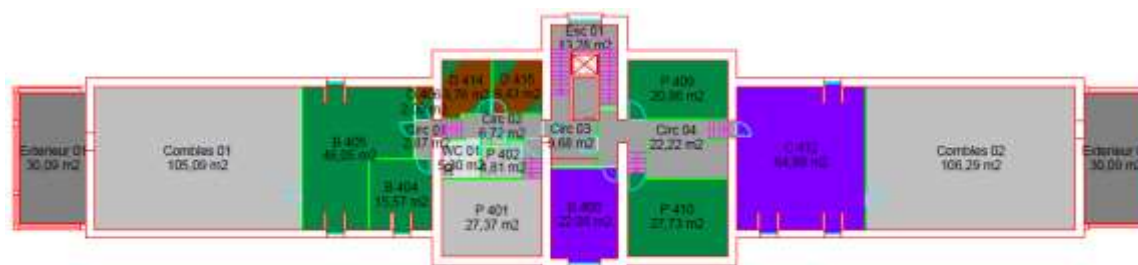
Plan du R+4 pavillon TAILLEFER – plan d'occupation 2020
